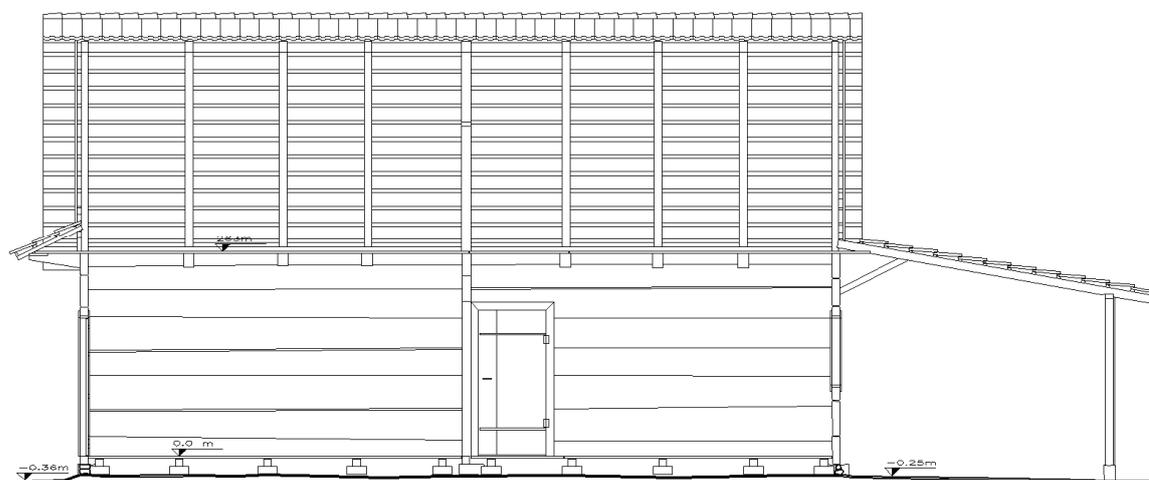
CORTE LONGITUDINAL, ESTRUTURA DA COBERTURA
